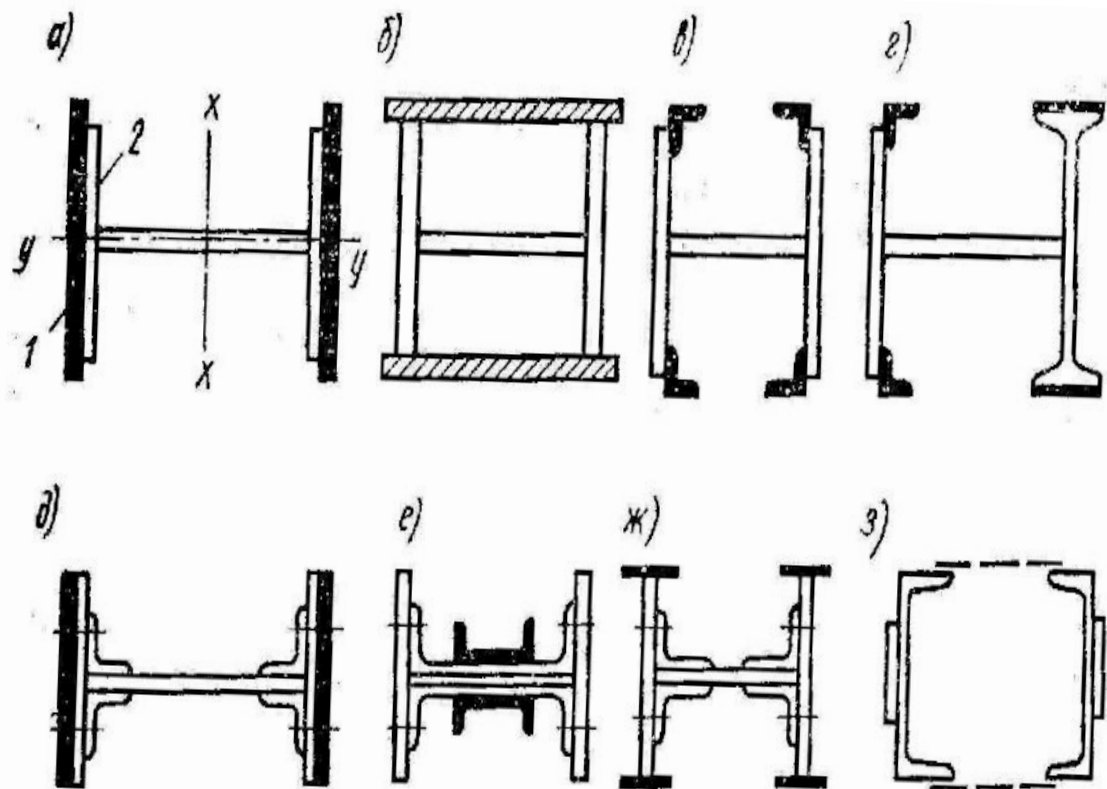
Схемы усиления колонн одноэтажных зданий увеличением сечений
